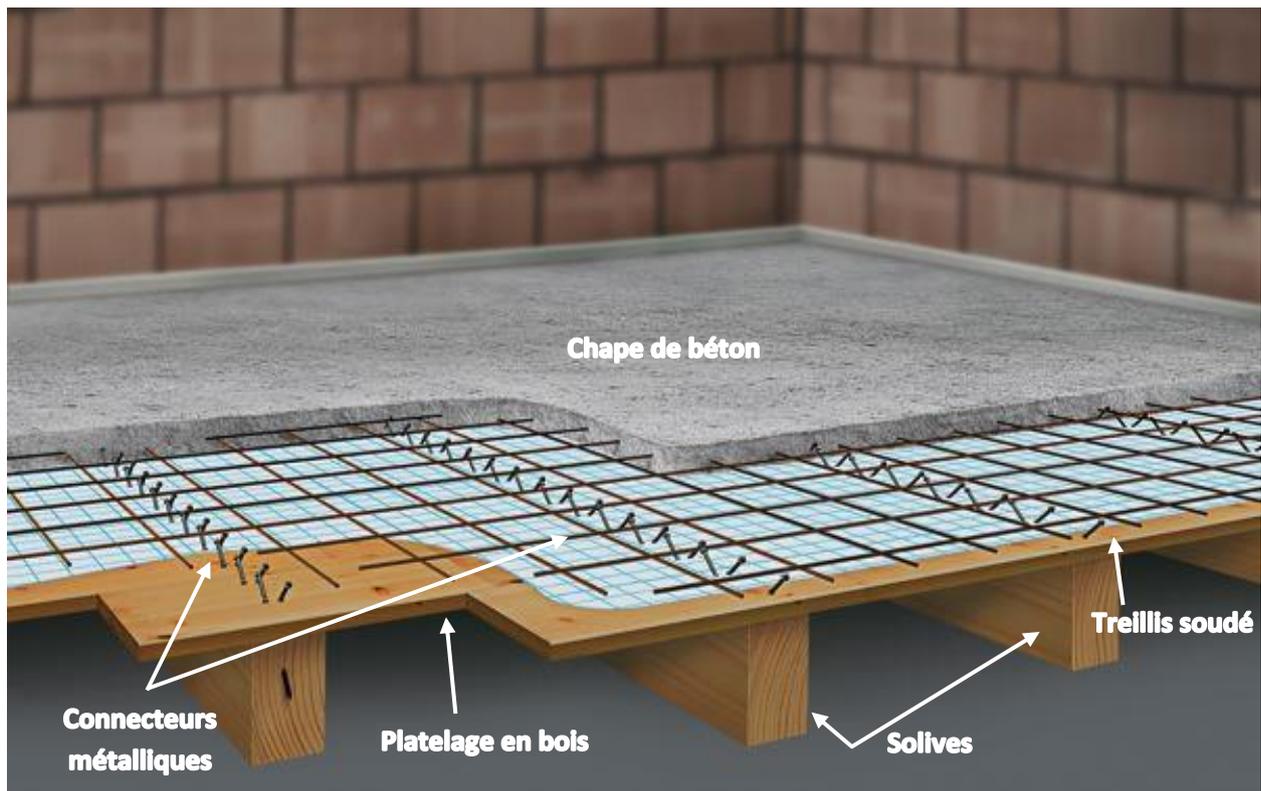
Plancher mixte bois-béton. Source : <https://batijournal.com/systeme-mixte-boisbeton-vb-nouveaute-eurobois-2011/88338>
